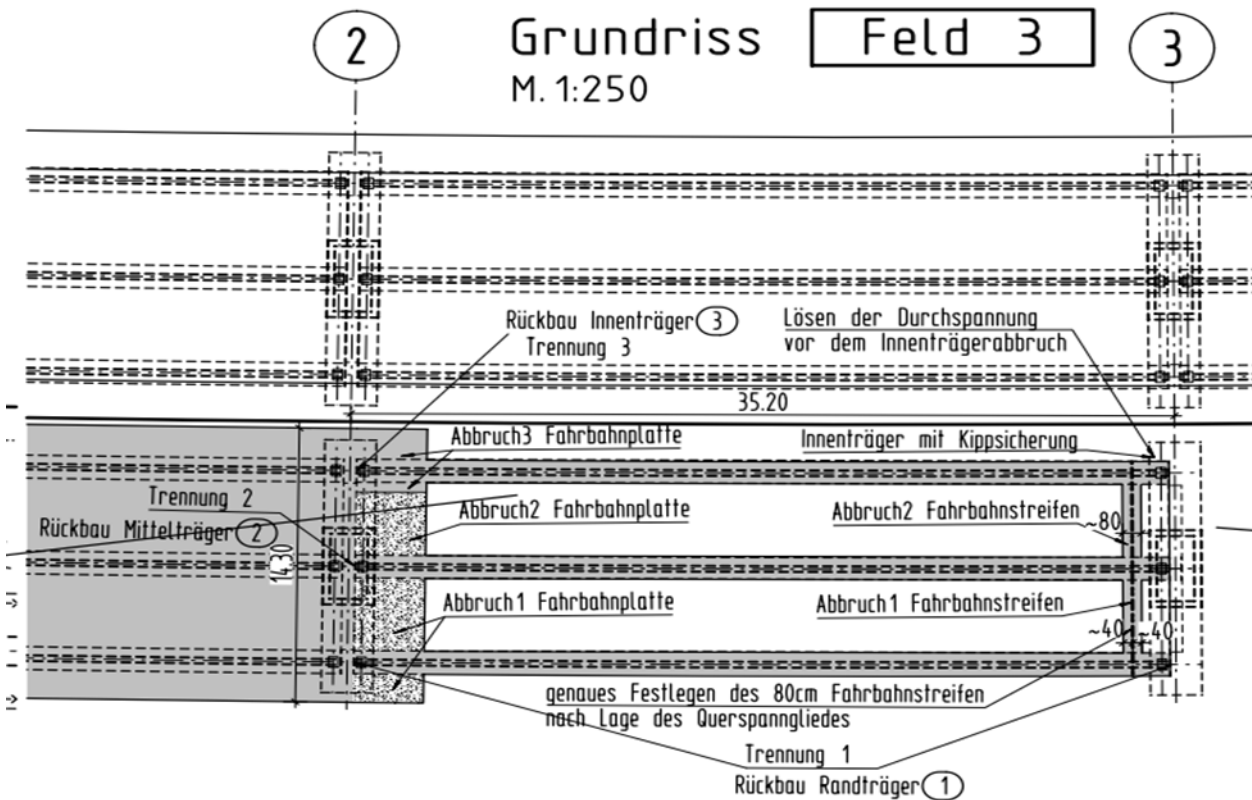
Abbruchfelder II, III, V, VI (© Adam Hörnig Baugesellschaft mbH & Co. KG)
